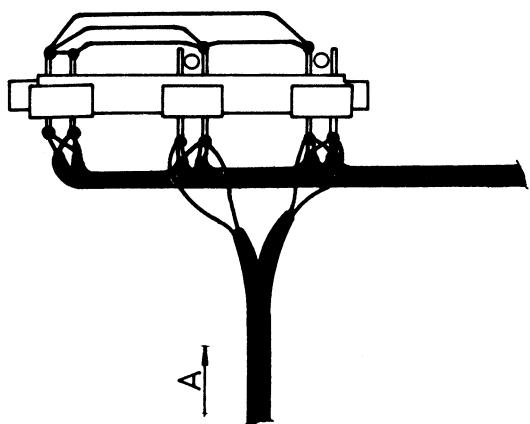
DETAIL ZAPOJENÍ SÍŤ VYPÍNAČE
